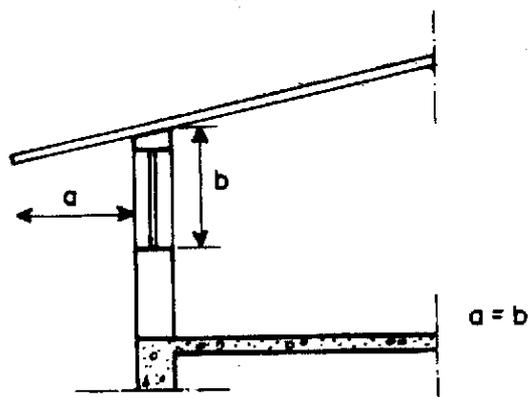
Dimensão de beiral para proteger aberturas entre telhado e forro.
